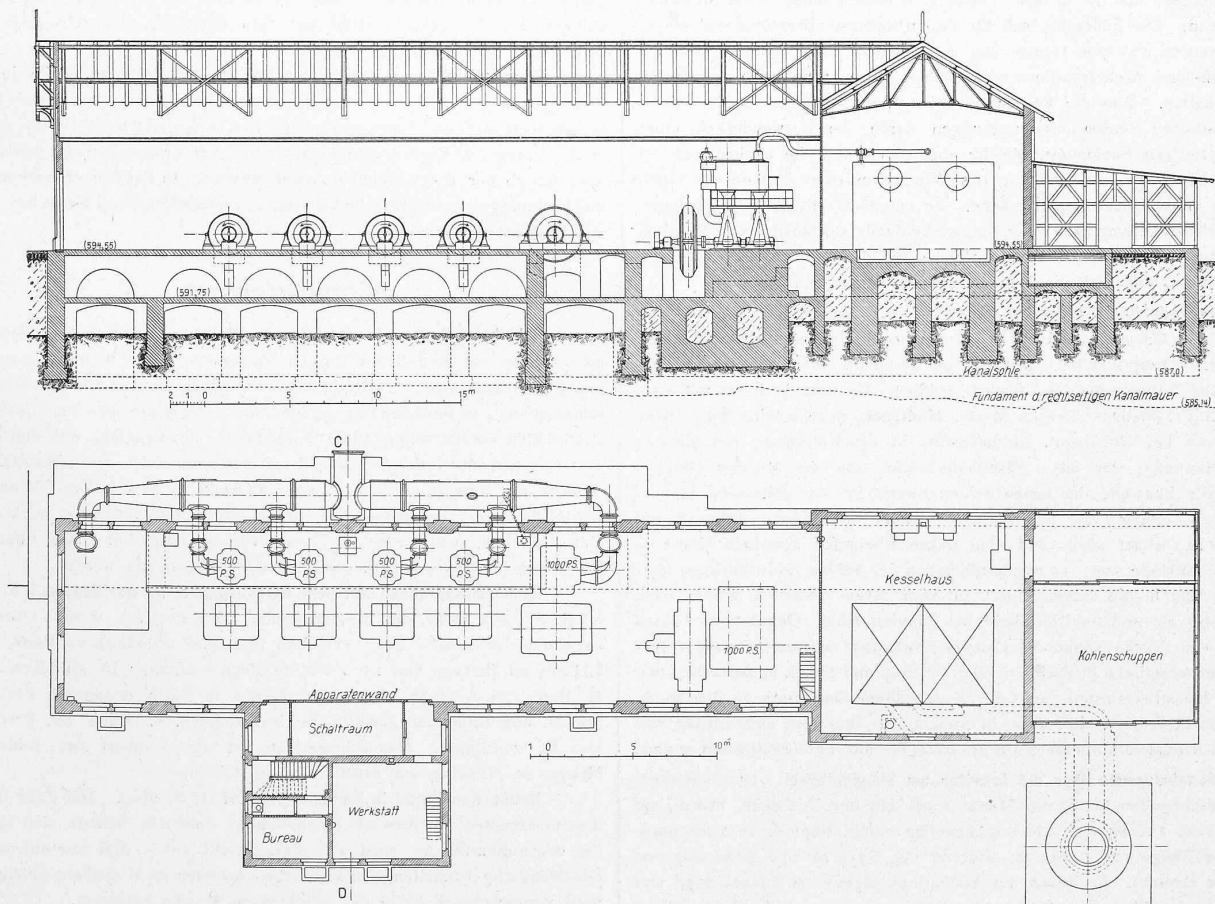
Grundriss und Längenschnitt des Maschinenhauses. — Masstab 1:400.
